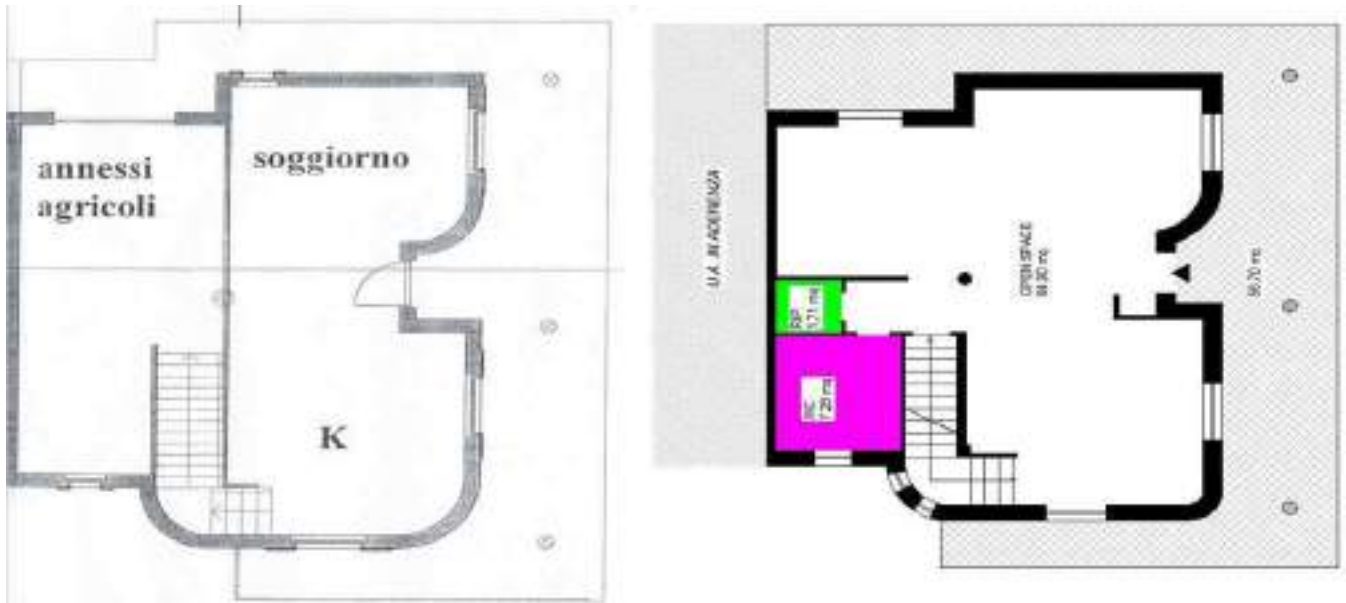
Sovrapposizione tra lo stato di fatto e il progetto assentito – Piano terra
